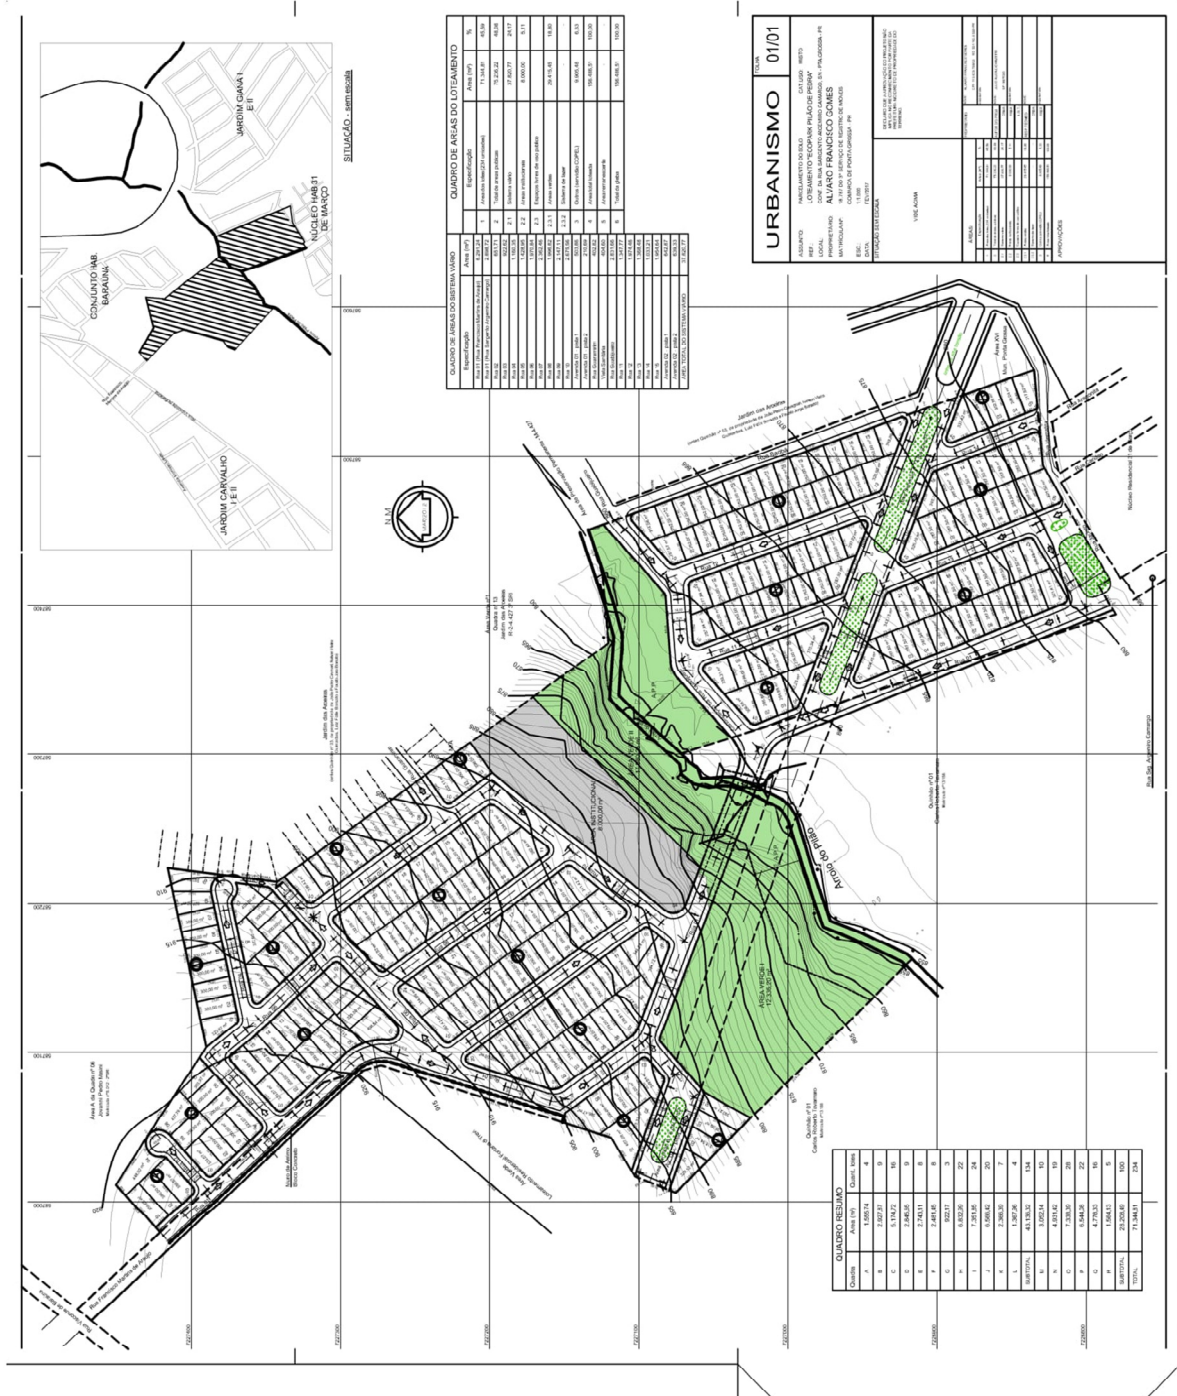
Projeto Urbanístico do Loteamento “Ecopark Pilão de Pedra”
